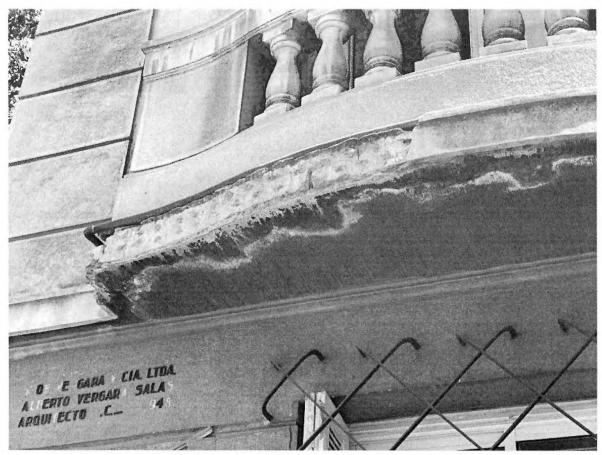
Detalle de desprendimiento en balcones de fachada sur.
